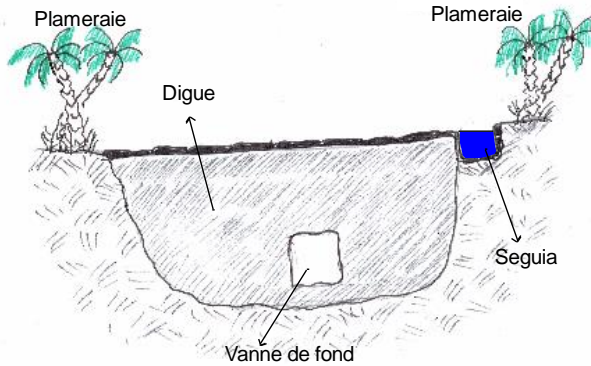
Schéma d'une coupe transversale d'un barrage de sources
